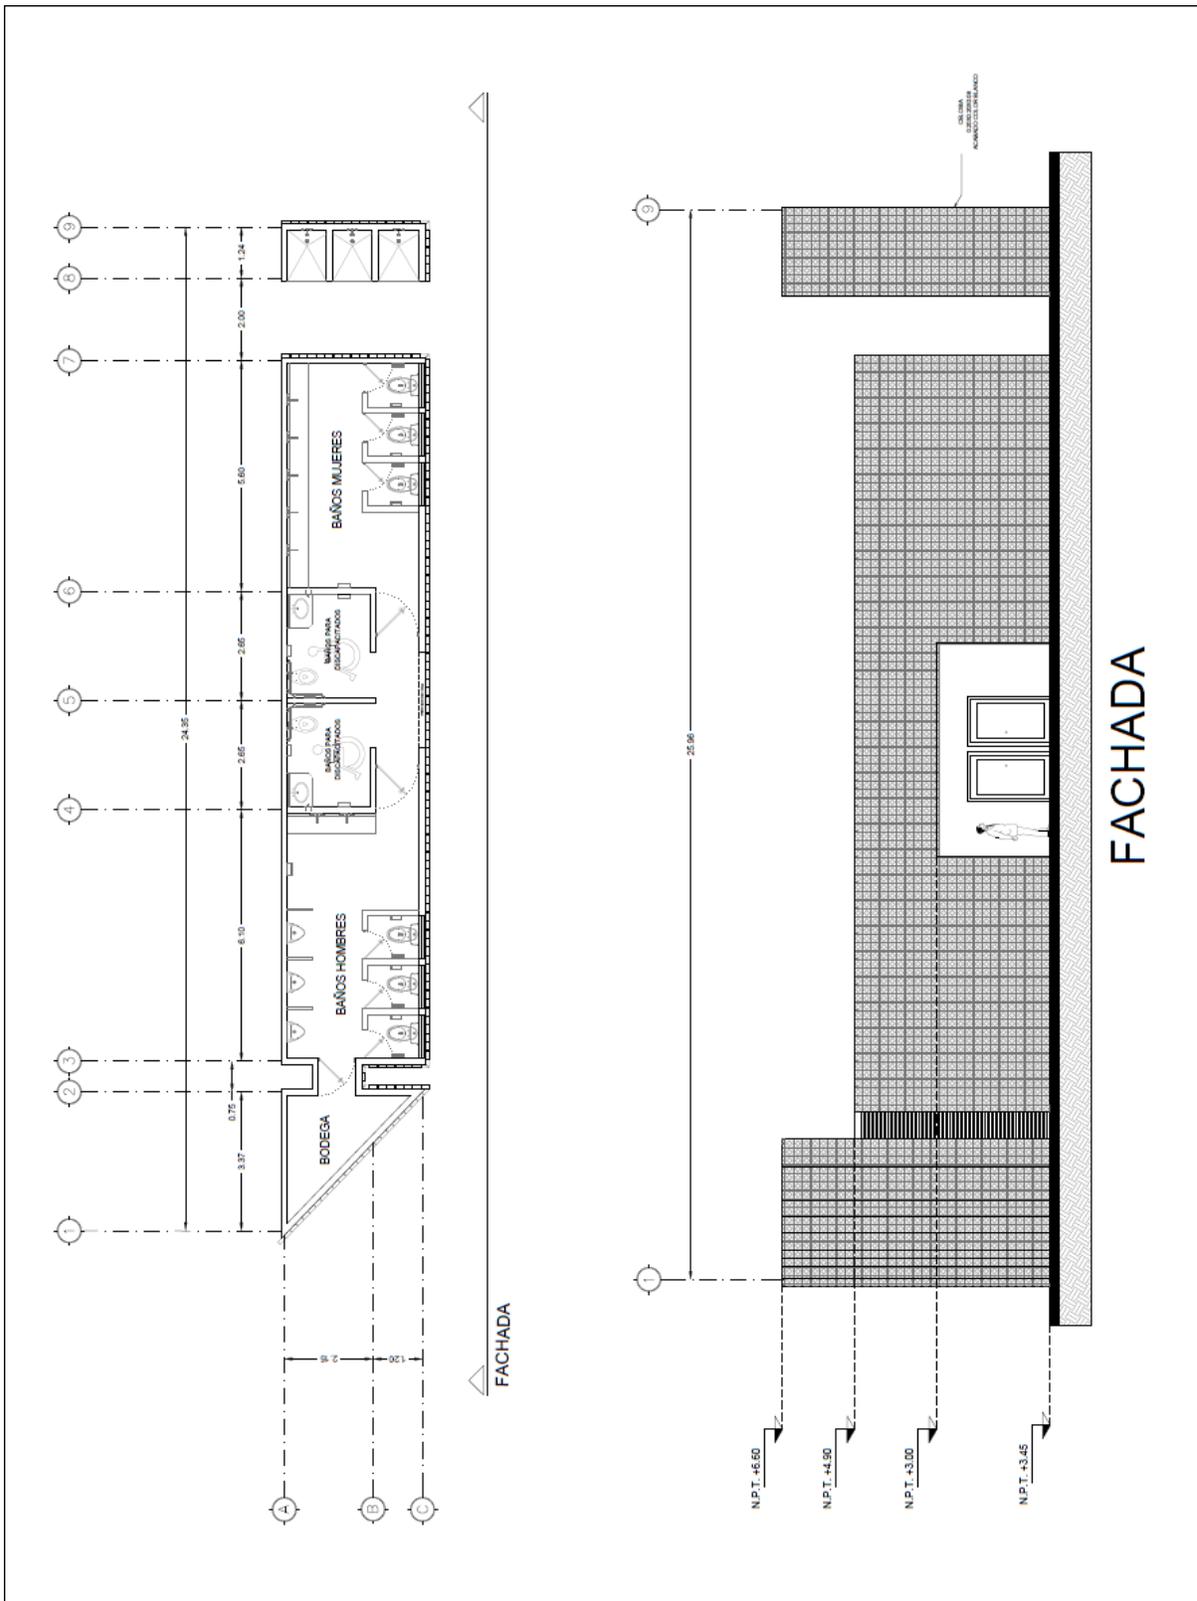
Planta arquitectónica y fachada de módulo de baños.
